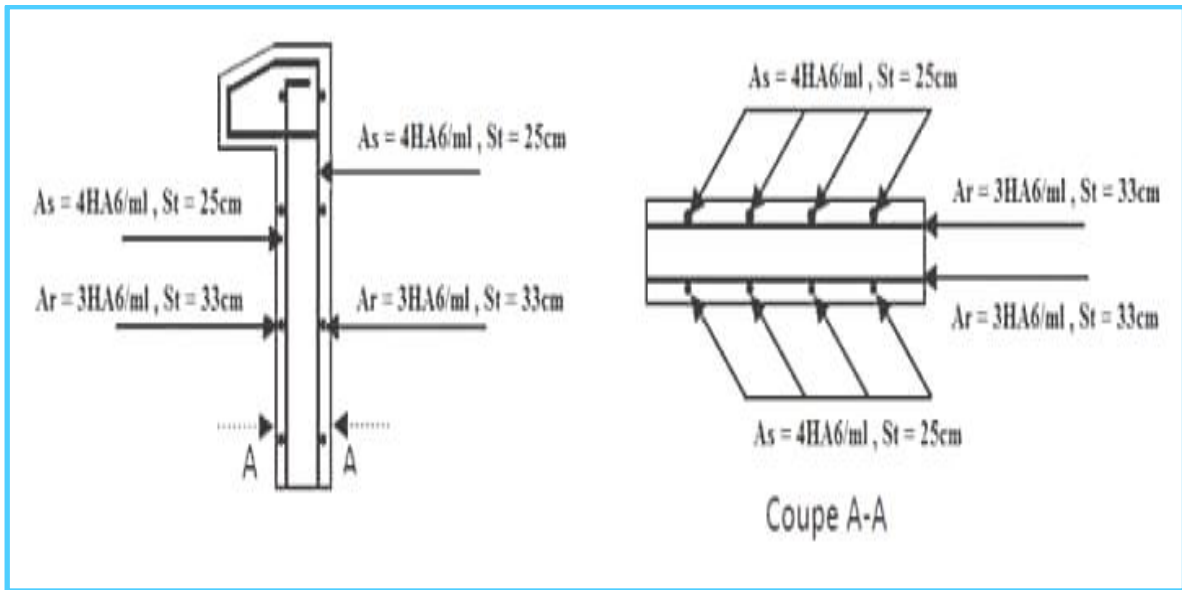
Schéma de ferrailage de l'acrotère.
